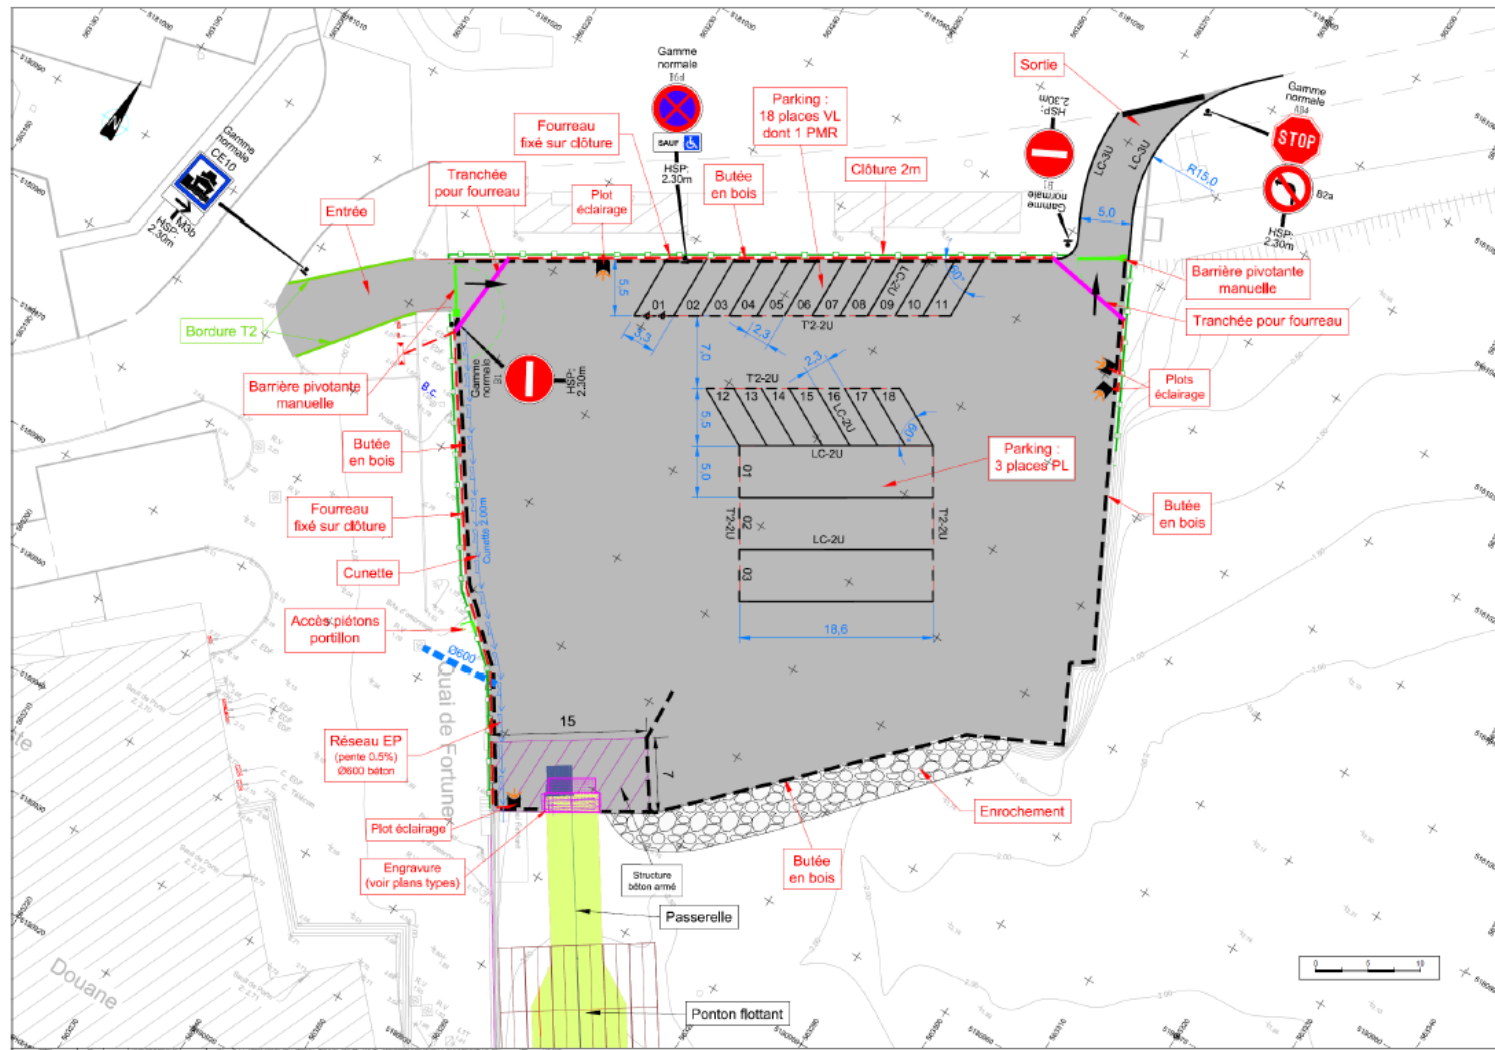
Plan des ouvrages du projet provisoire (source : setec international, 2017)
